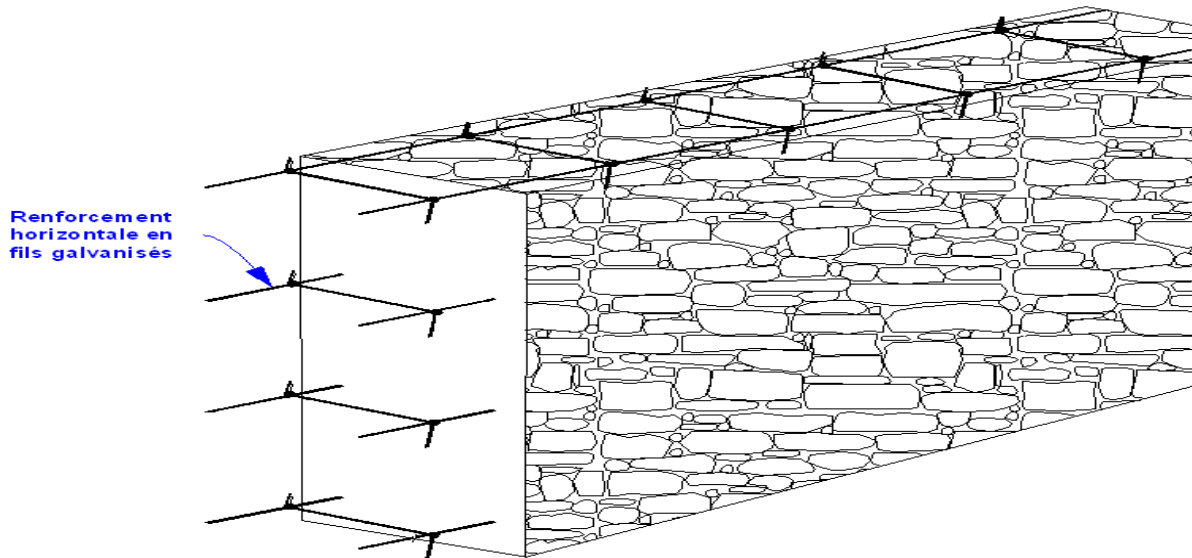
Renforcement horizontal par grillage en fils galvanisés
